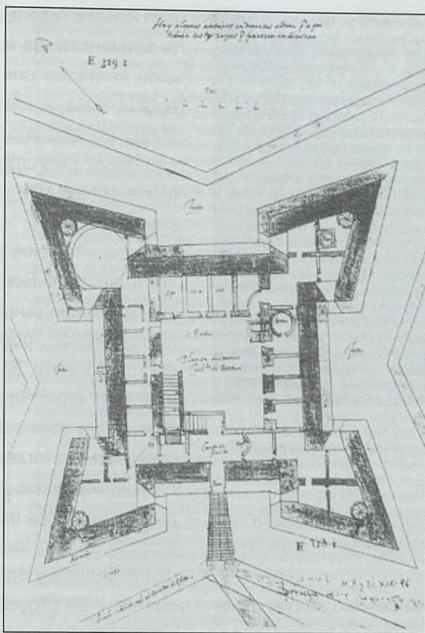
Plano de Antonelli con la planta de la fortaleza
